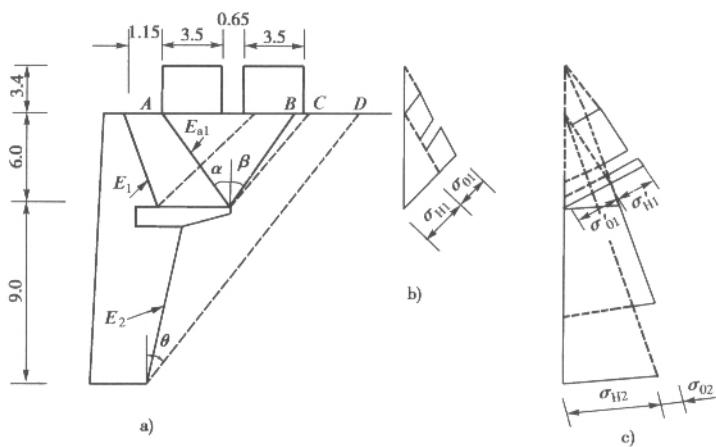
5—2 墙身计算断面及荷载布置(尺寸单位:mm)
